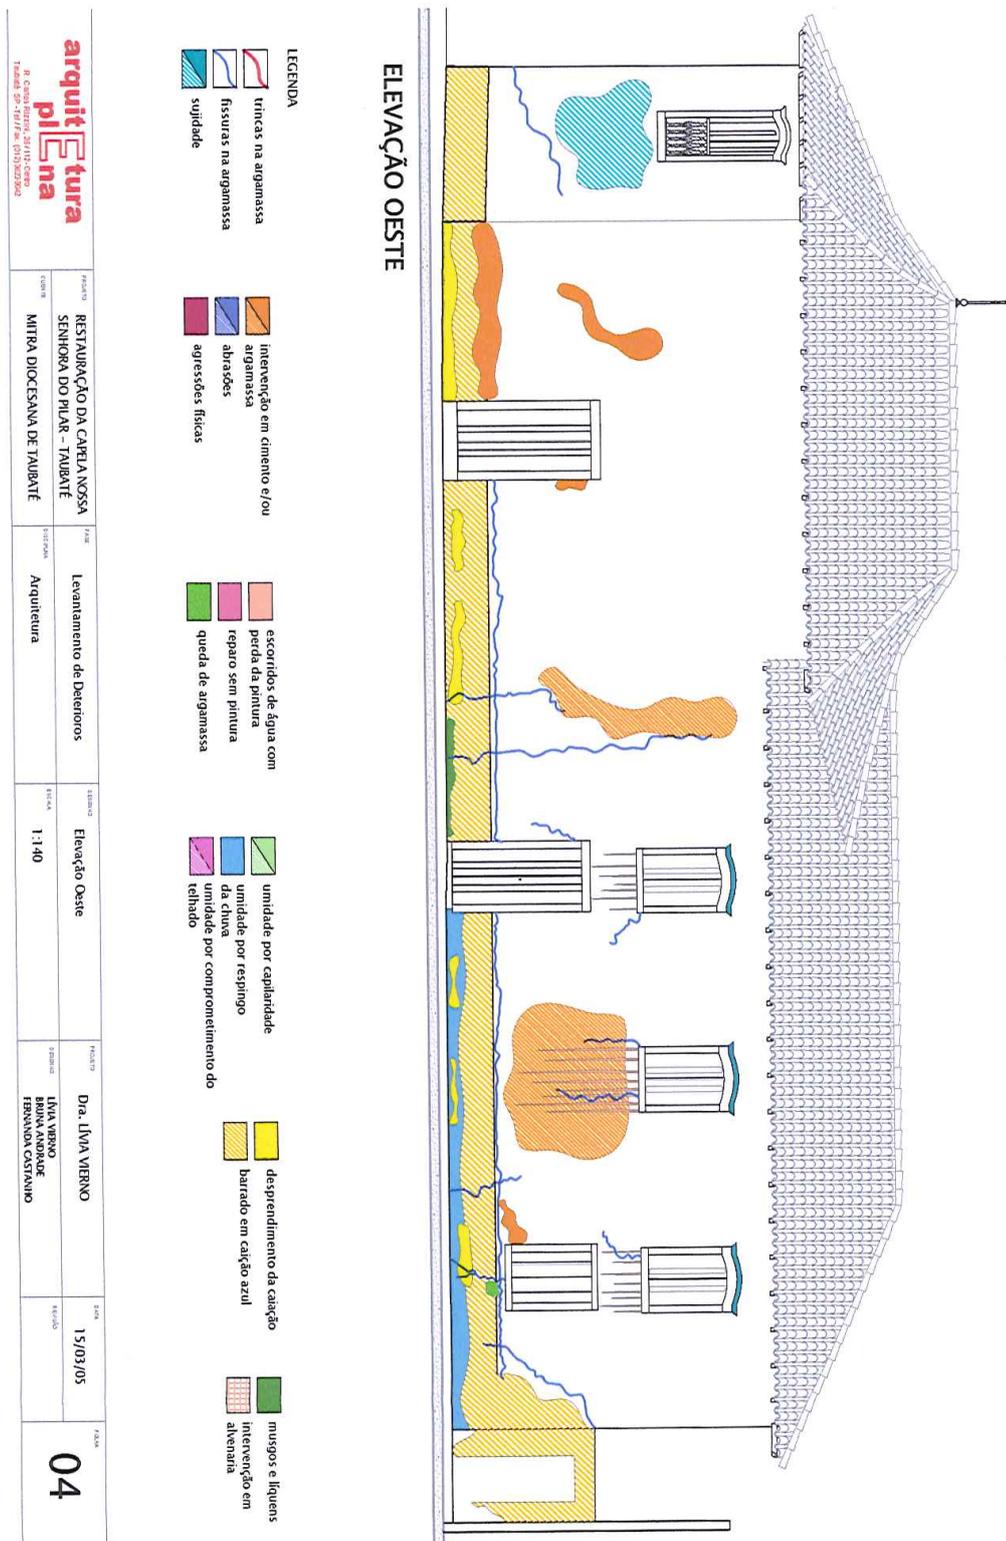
Levantamento deterioros Capela N. S. do Pilar, Taubaté/SP, 2005. Fonte: Arquitetura Plena.
